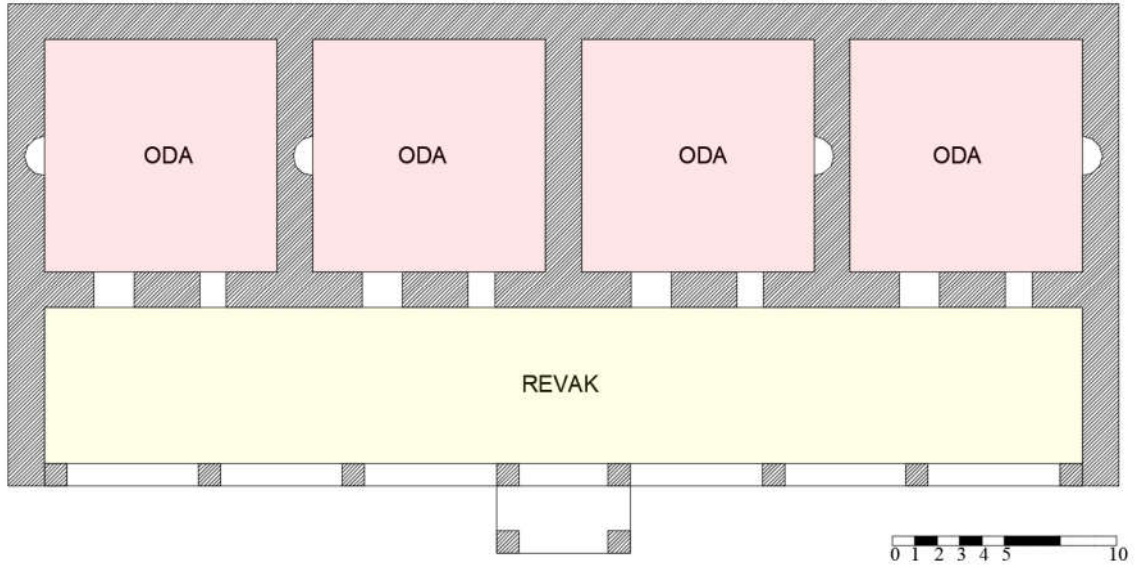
30 Kurşunlu Külliyesi vaziyet planı
